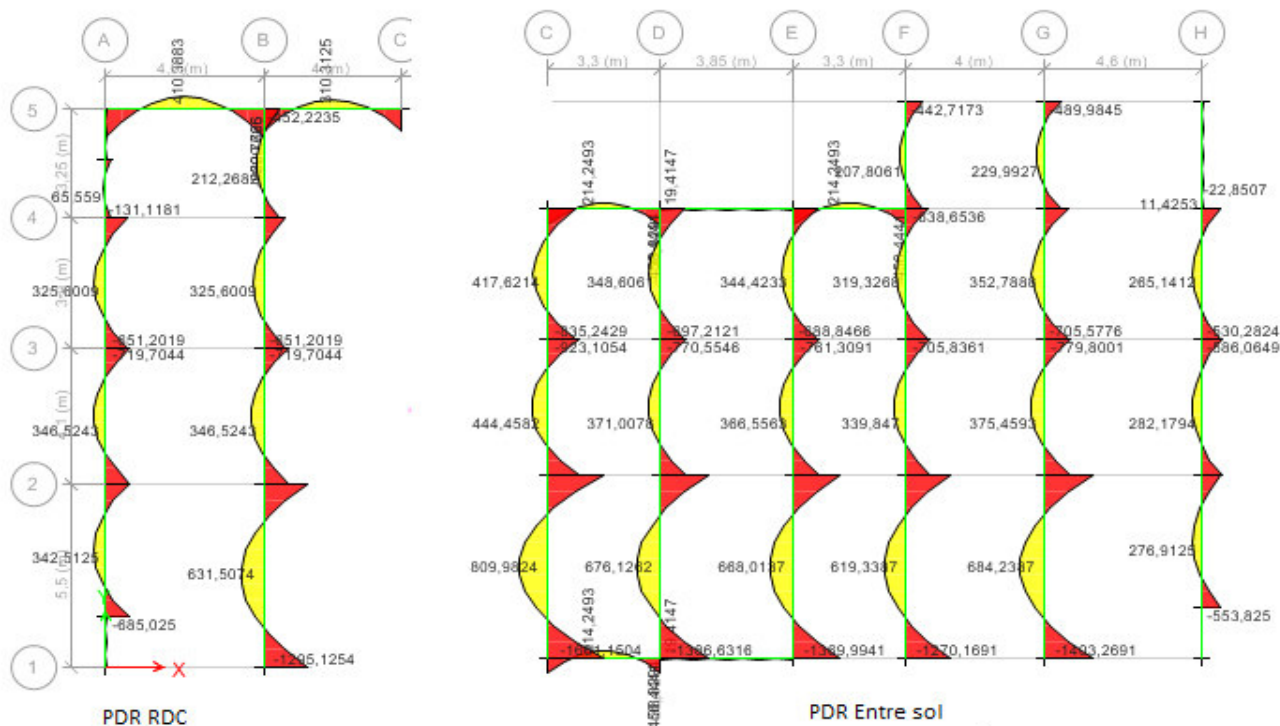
Sollicitations agissantes sur la poutre de rigidité.
